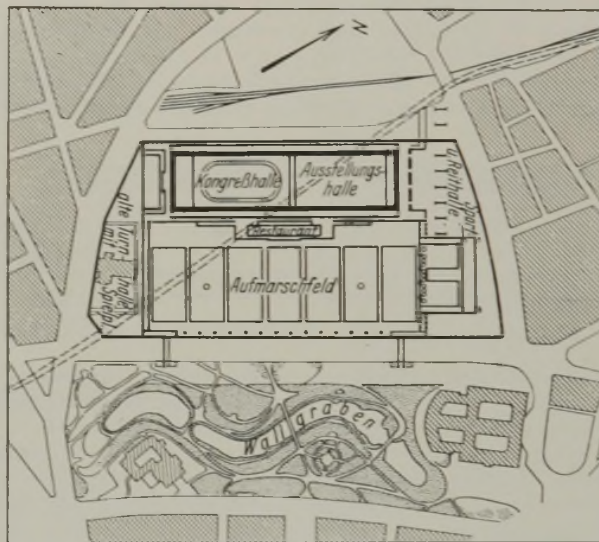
Lageplan. Entwurf Hermann Distel, Hamburg.
